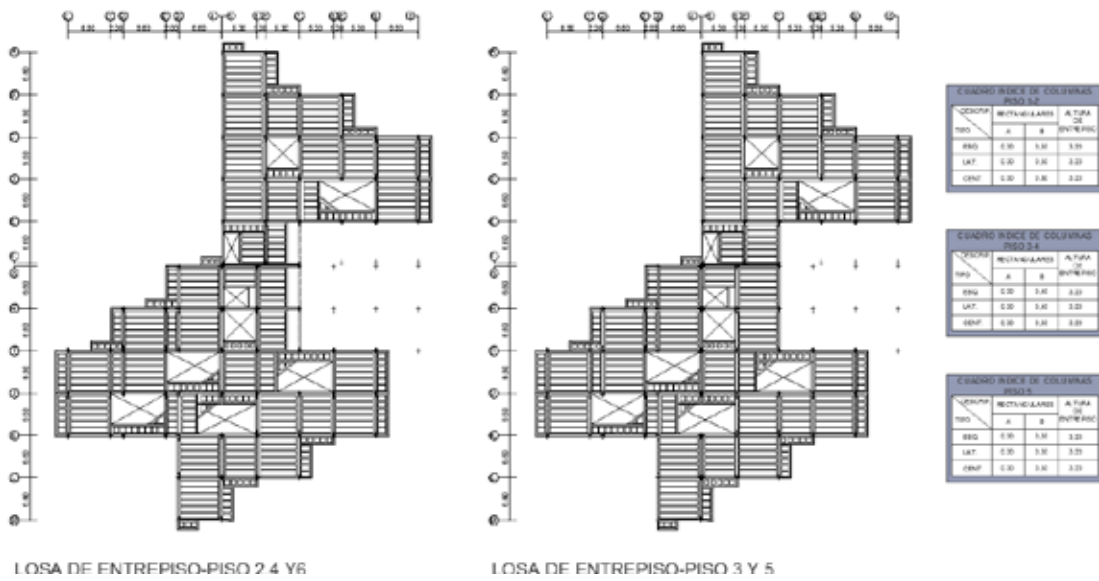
Envigado losa de entrecaposo – Plantas tipo
